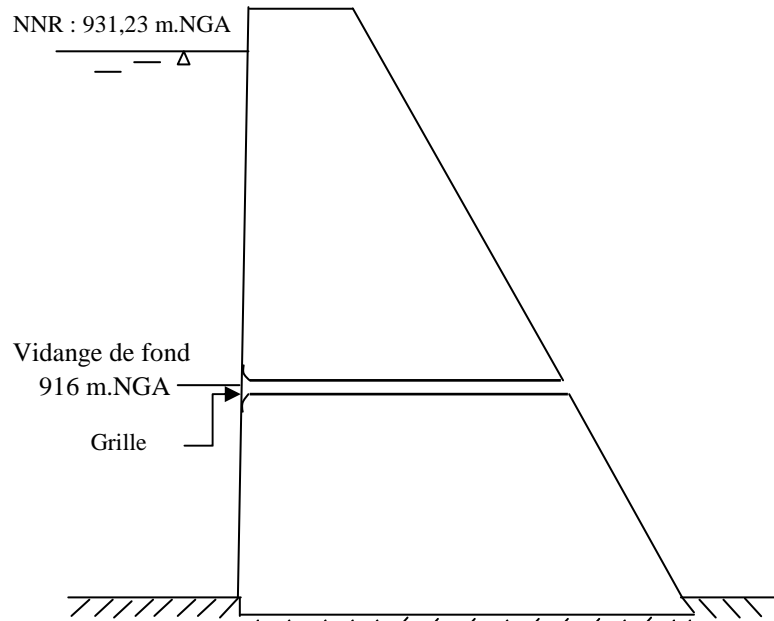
Coupe transversale dans le barrage montrant la vidange de fond.
